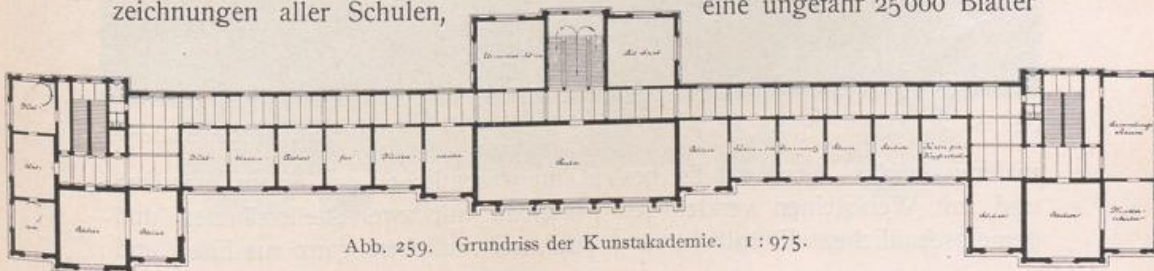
Grundriss der Kunstakademie. 1:975.
